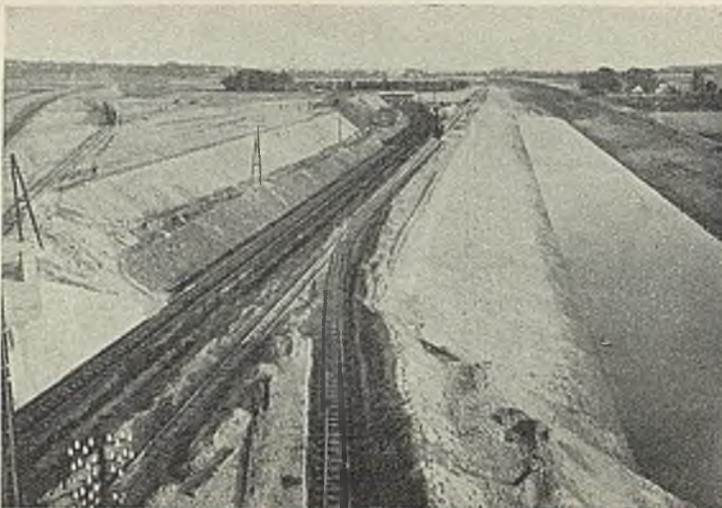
Mittellandkanal. Kanalschlauch von km 124,6—125,5 mit teilweiser Uferbefestigung (rechts).
